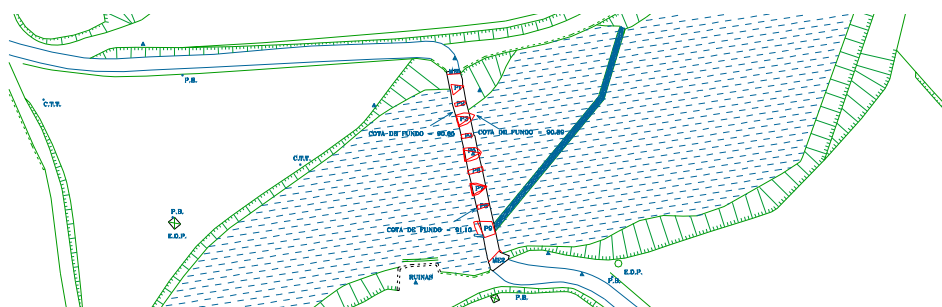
3 – Planta da envolvente do local e localização da ponte antiga
